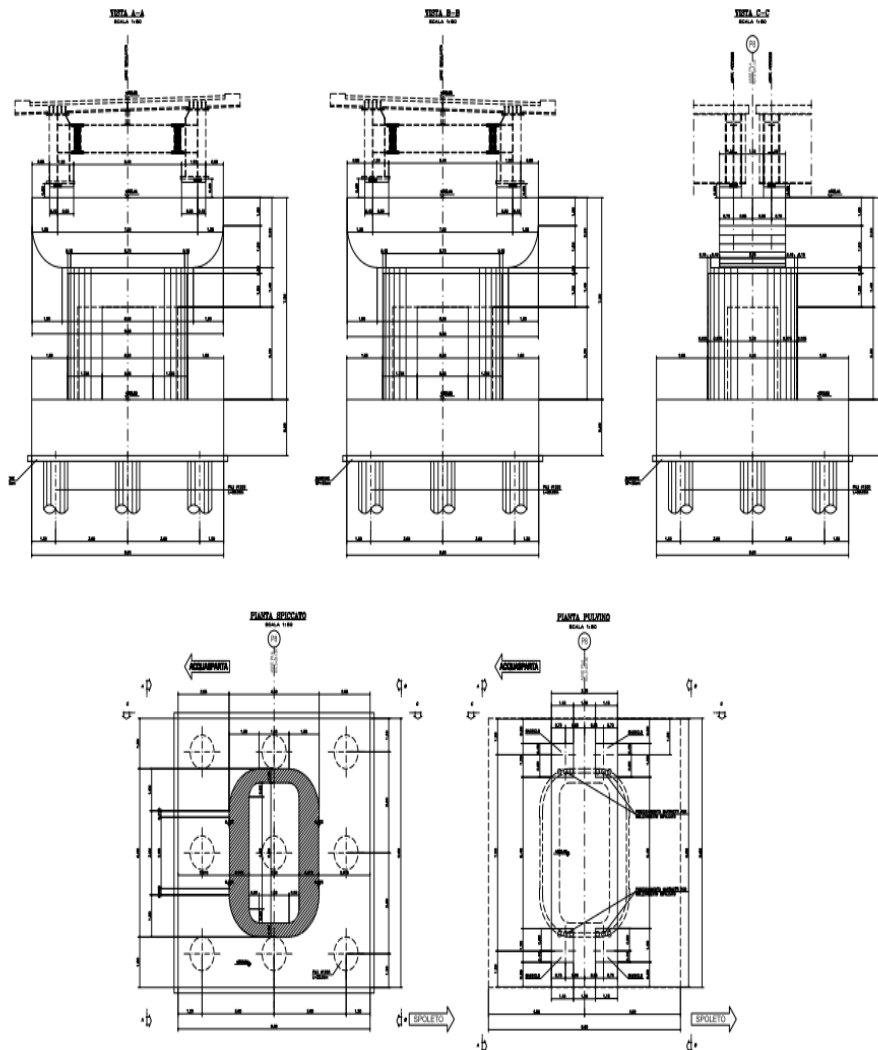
sezione e pianta su pila-spalla (8)
